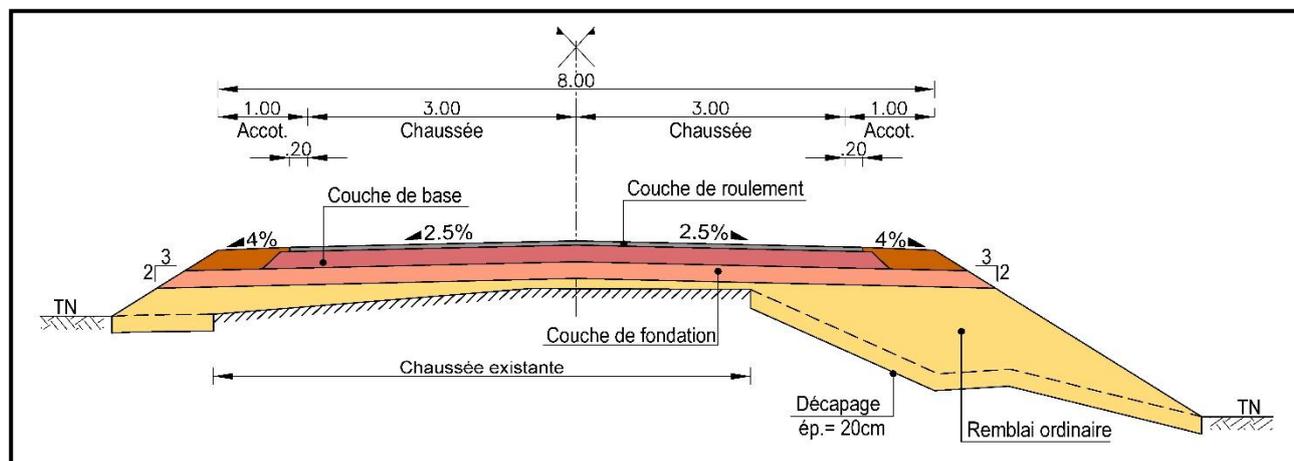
Secção transversal tipo 1 - Estrada de ligação à ponte sobre o rio Lembá
